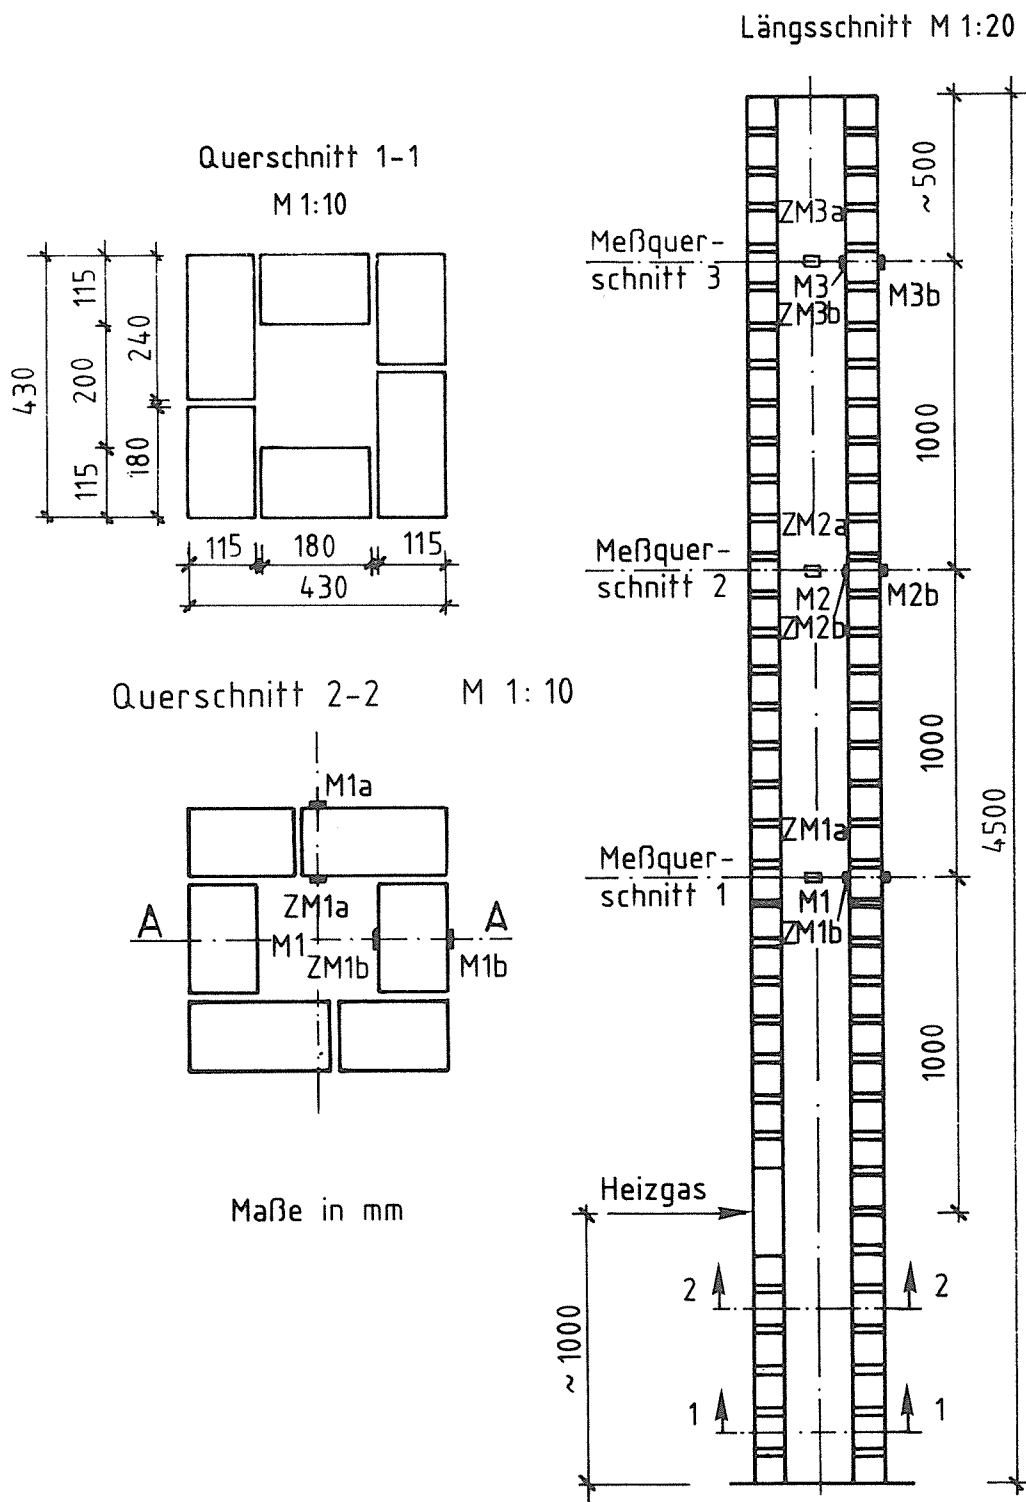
Prüfschornstein und Lage der Thermolemente [21]
